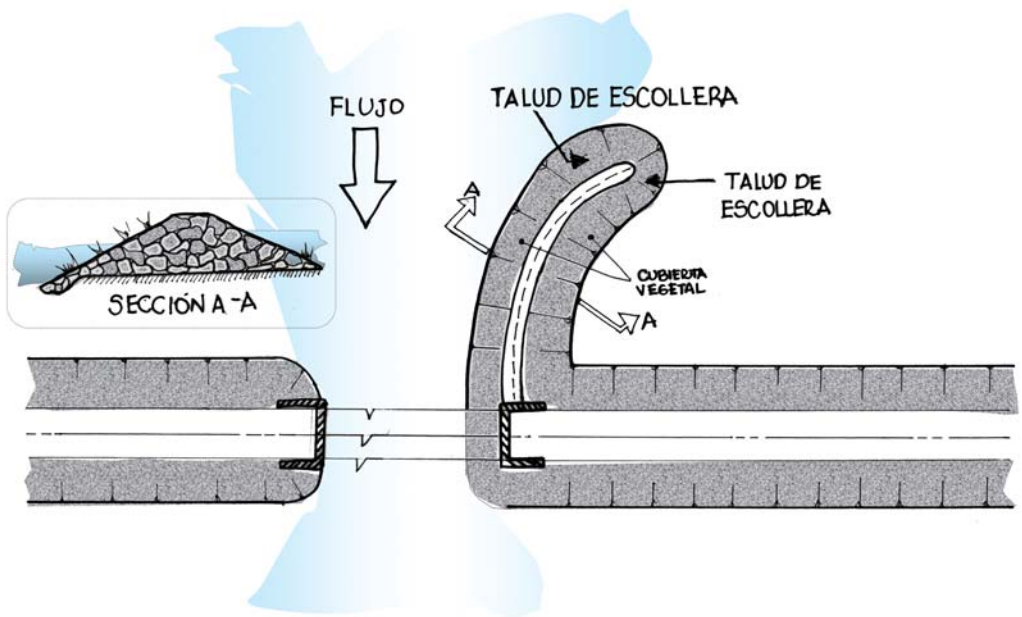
Típico dique-guía. Planta y sección transversal.
